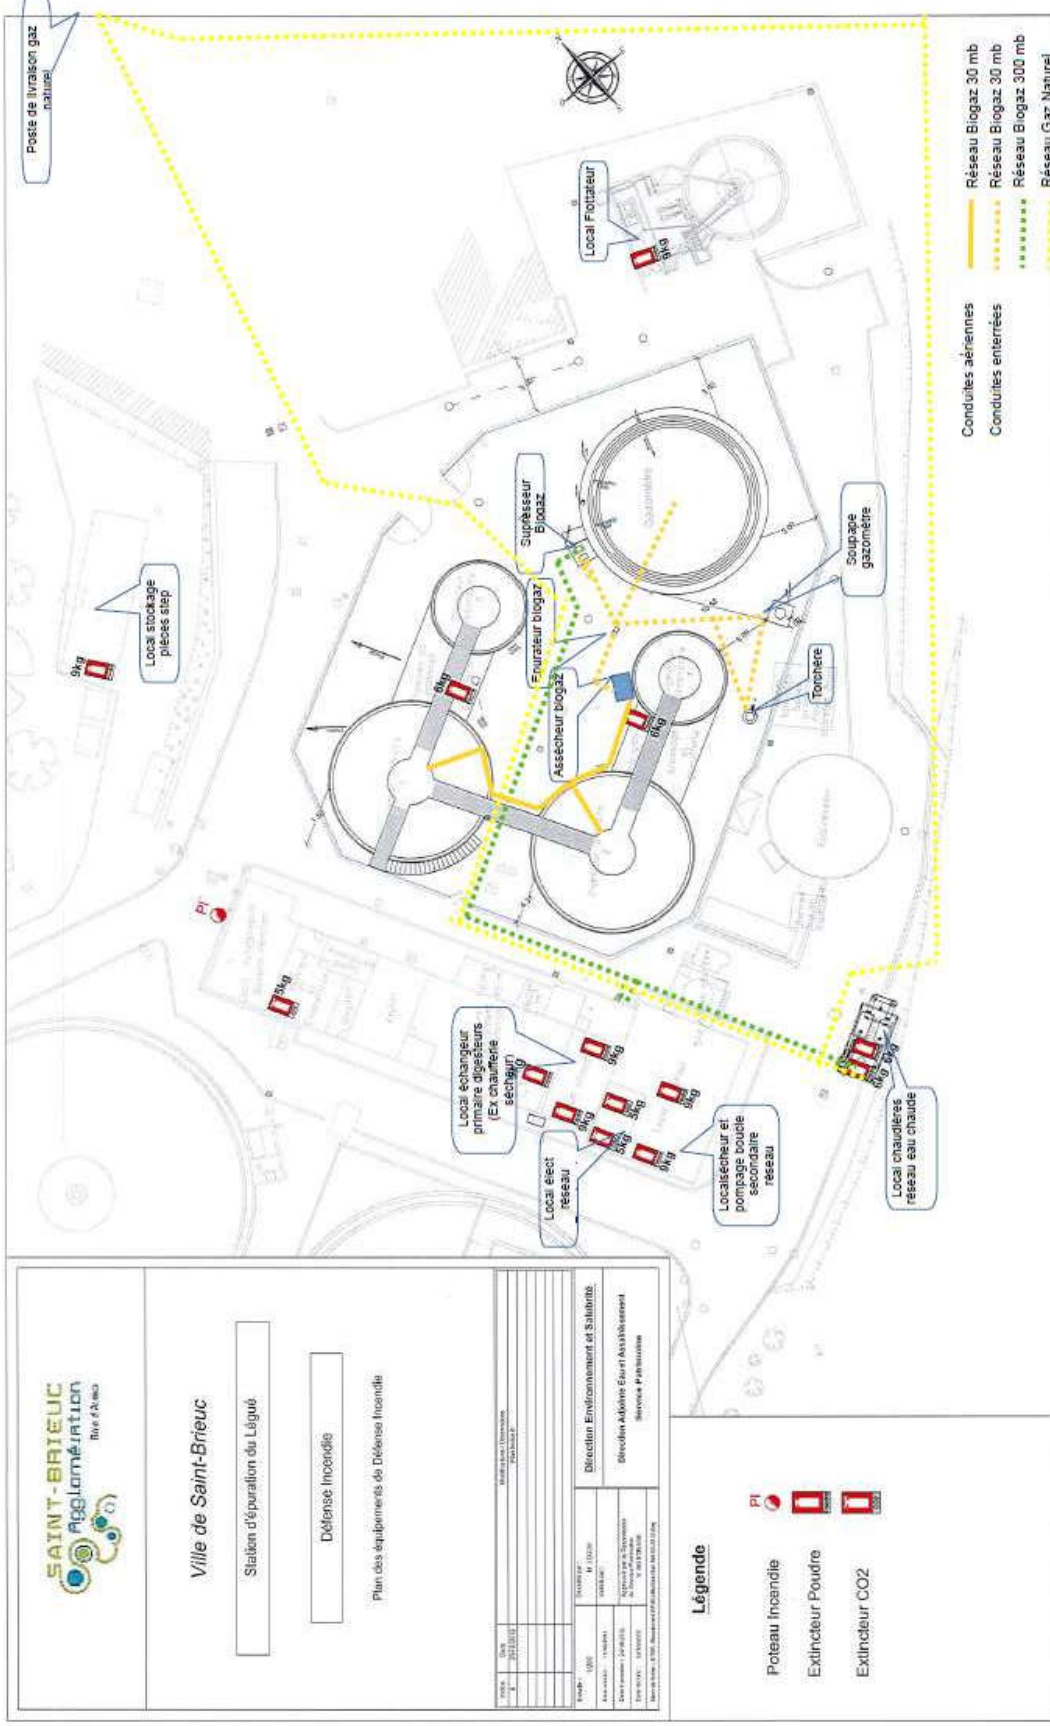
Implantation générale des digesteurs primaires et secondaires, des conduites biogaz et du gazomètre (Source : SBAA 2022)
